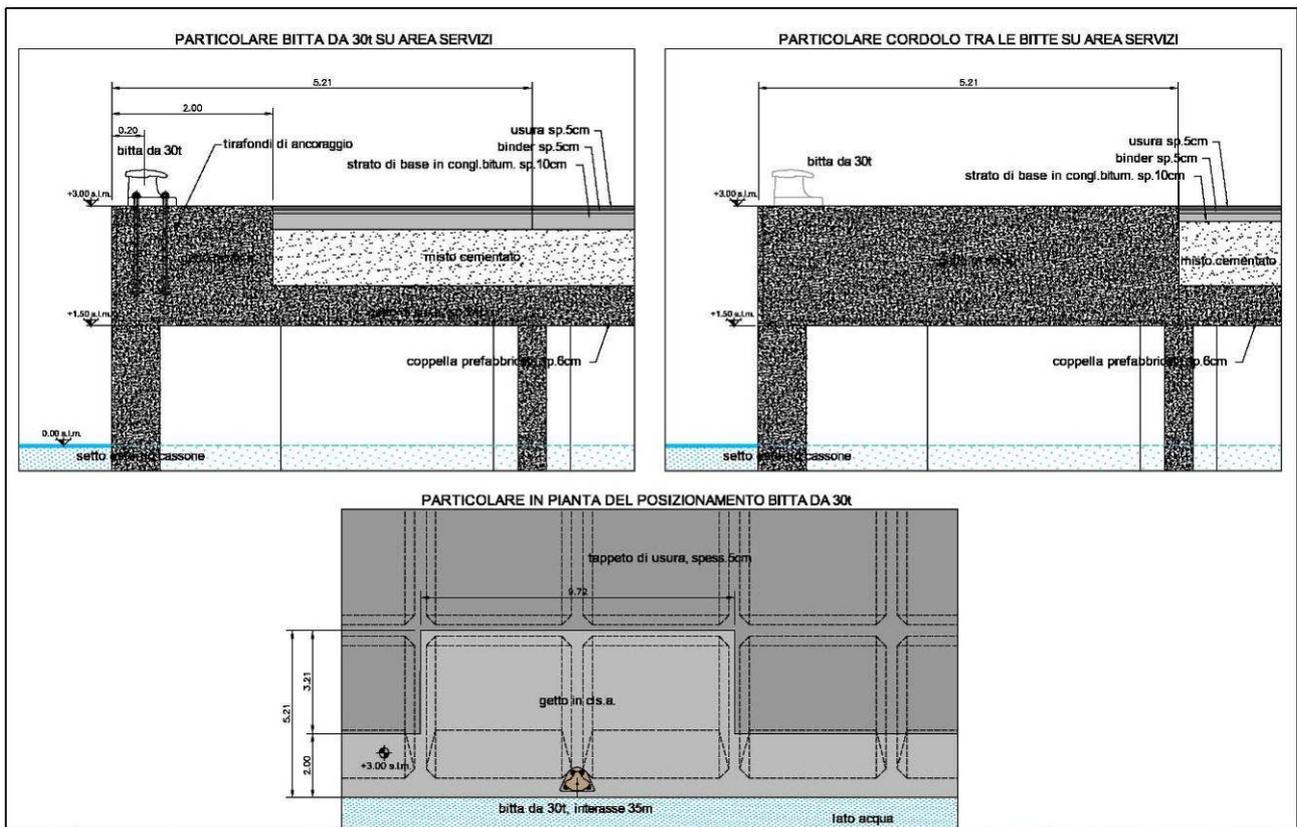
Banchina servizi – particolare della bitta di ormeggio da 30 t.
